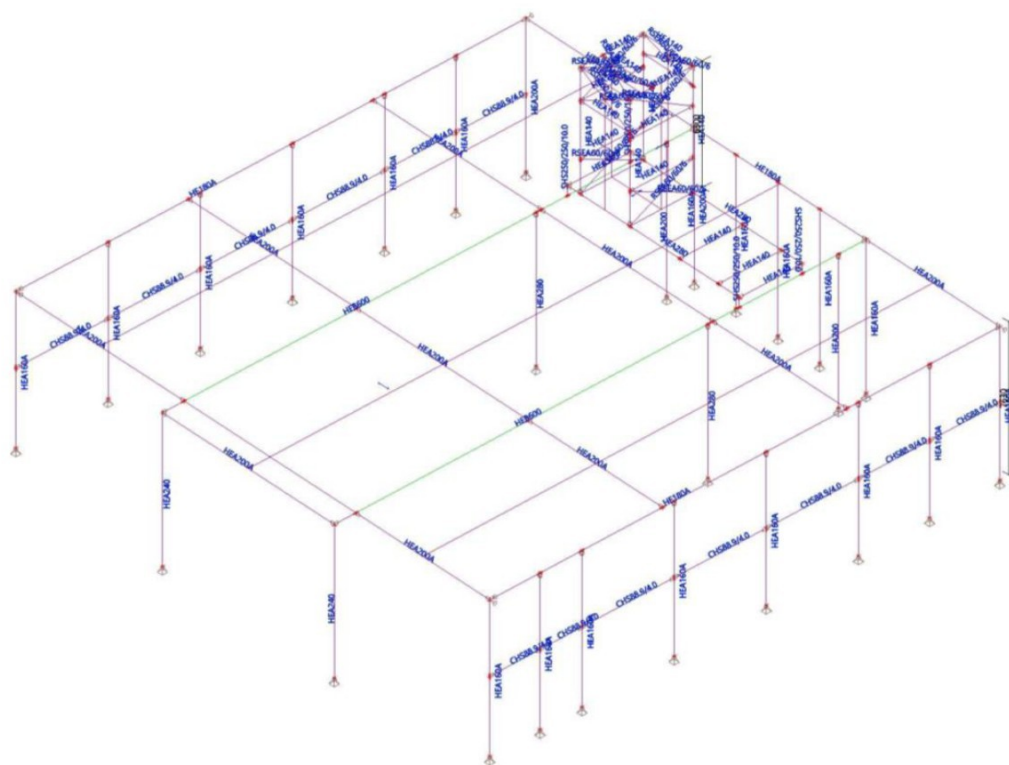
Stabiliteit – overzicht bestaande staalconstructie achterzijde
